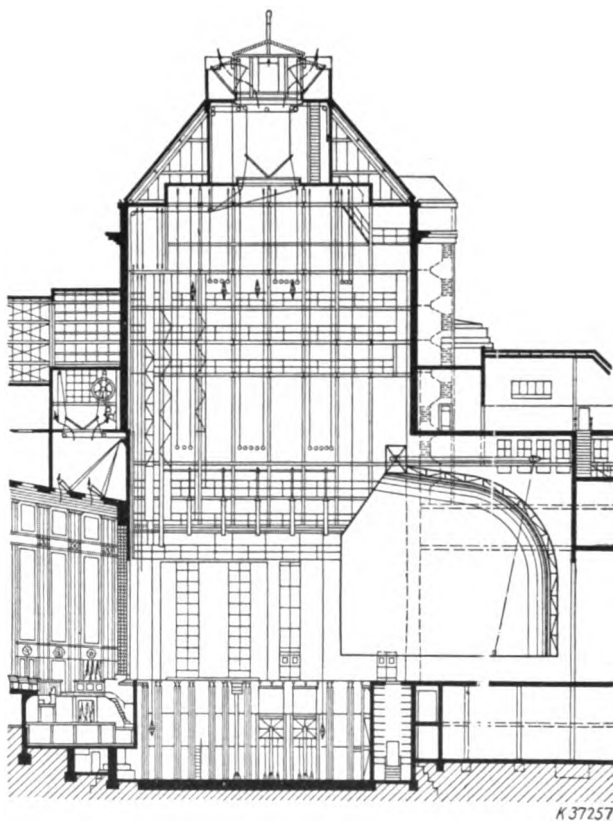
Längsschnitt durch das Bühnenhaus. Rechts der „Horizont“.
